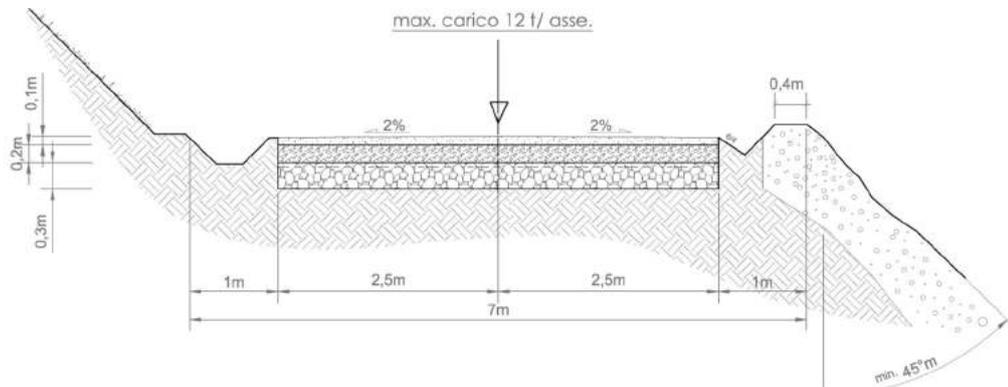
Sezione stradale tipo con scarpata (mezza costa)
